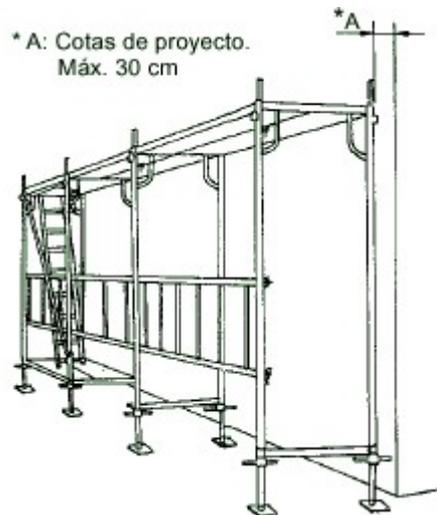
Encadenado del andamio y comprobación de la separación de la fachada
